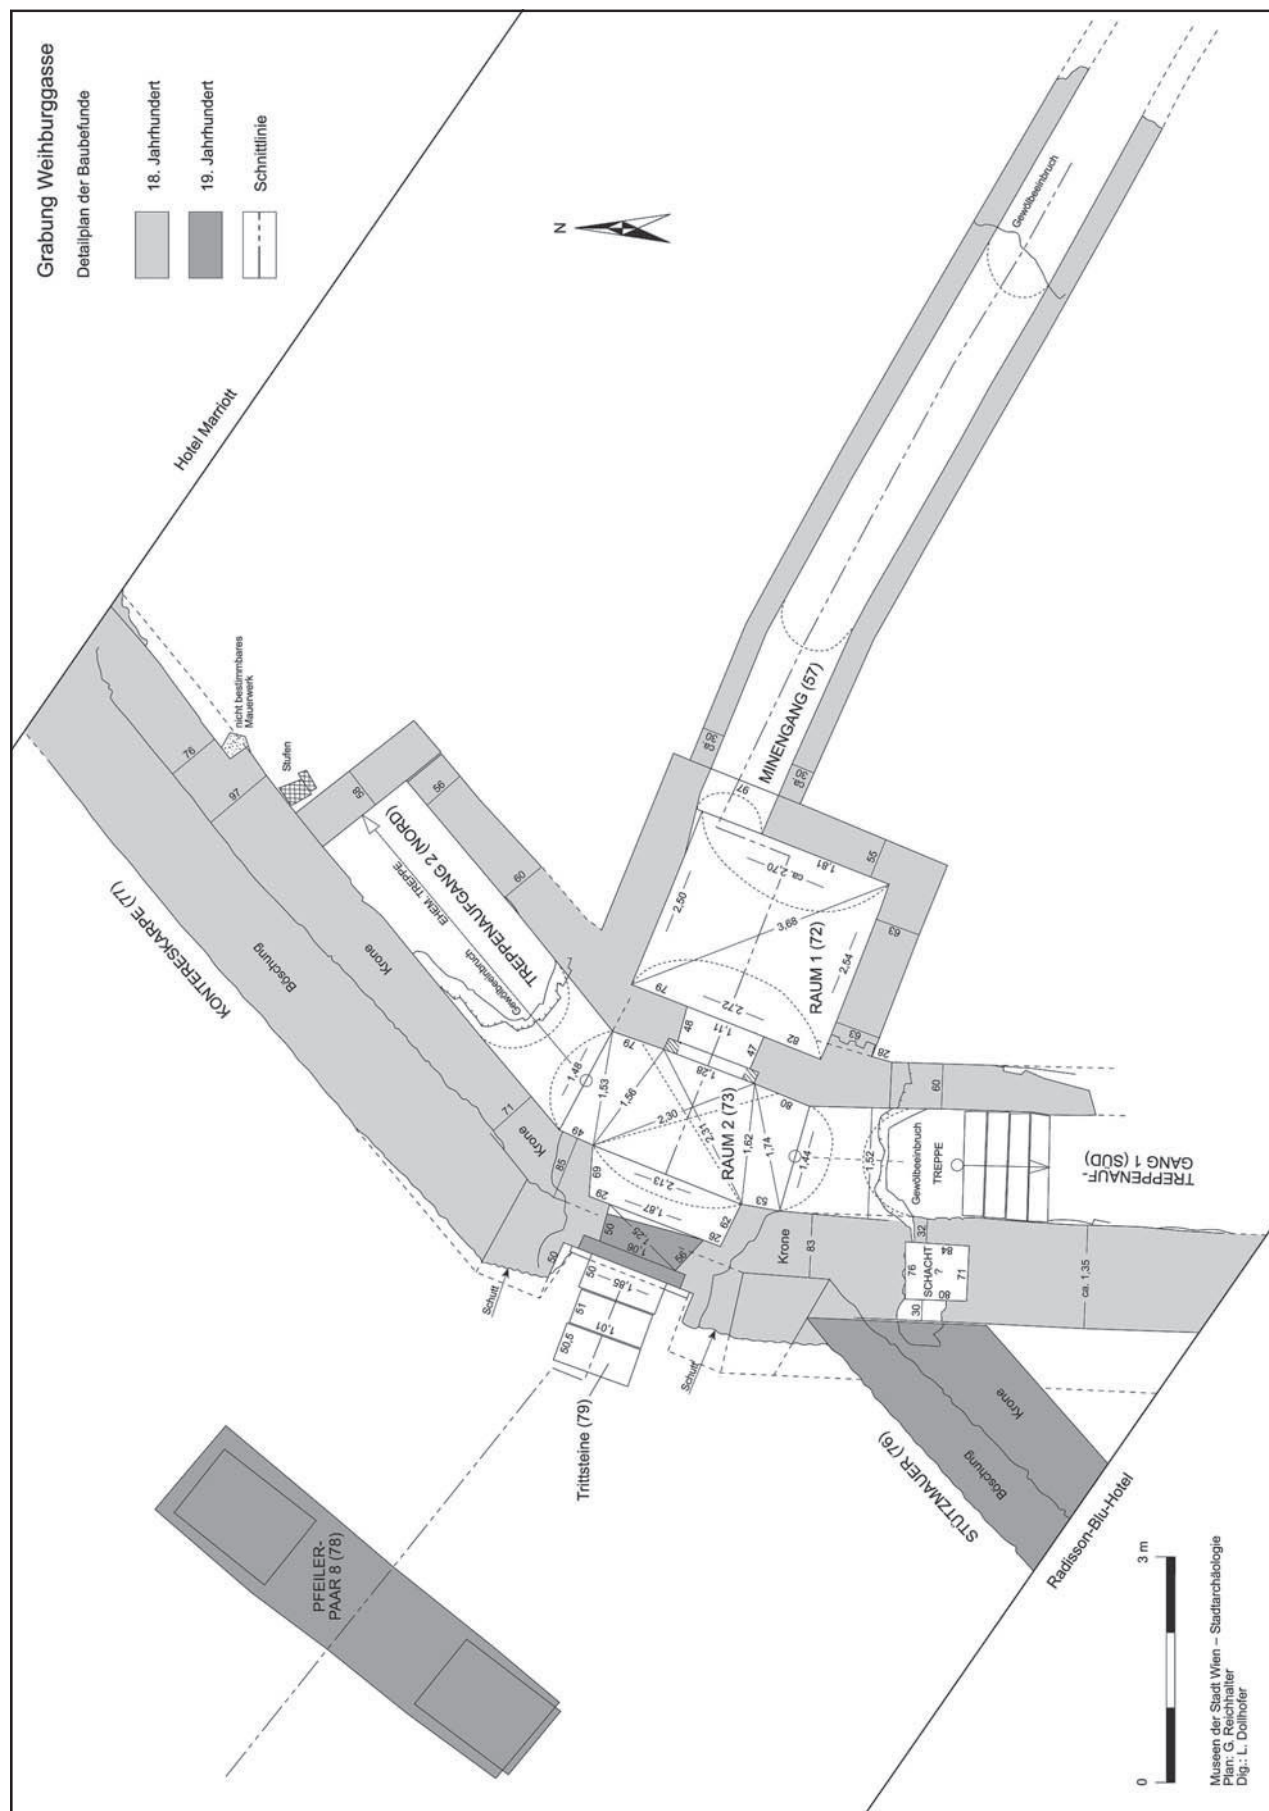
Wien 1, Weihburggasse 32, Detailplan der Mauerwerksbefunde. (Plan: G. Reichhalter/L. Dollhofer)
